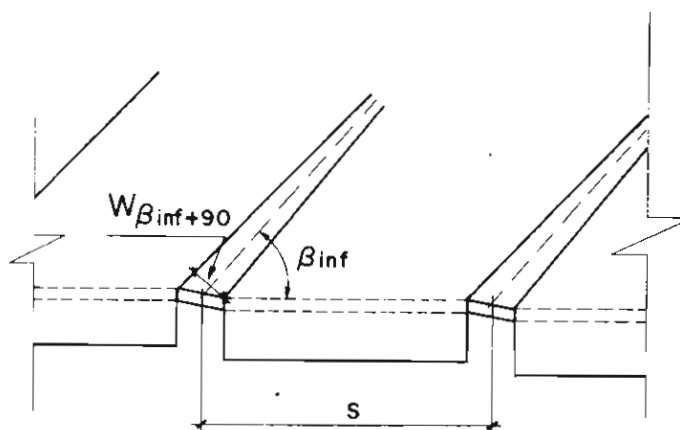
Modelo de anchura de fisuras en el nivel de la armadura de tracción.
